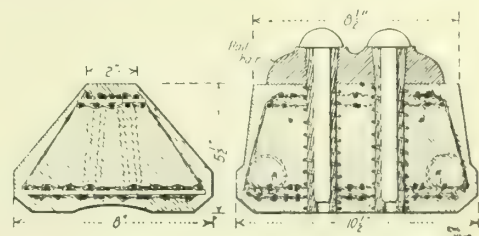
Eisenbeton-Schwelle J. P. Jagger
